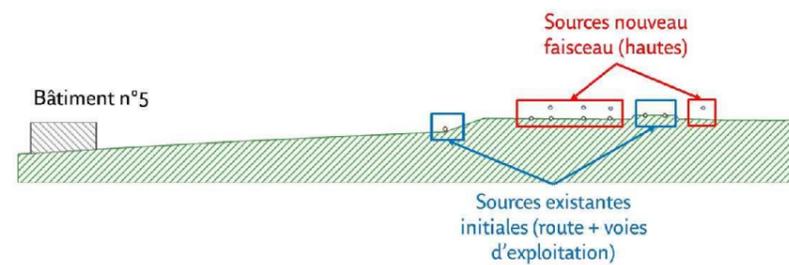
Coupe au droit du bâtiment n°5 par rapport au faisceau de voies.
